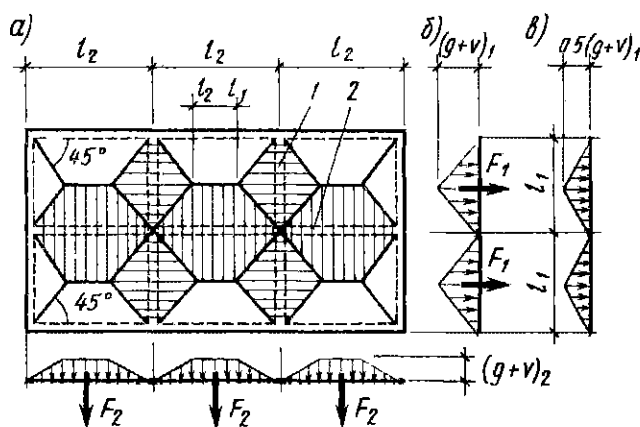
Расчетная схема балок перекрытий с плитами, работающими в двух направлениях
